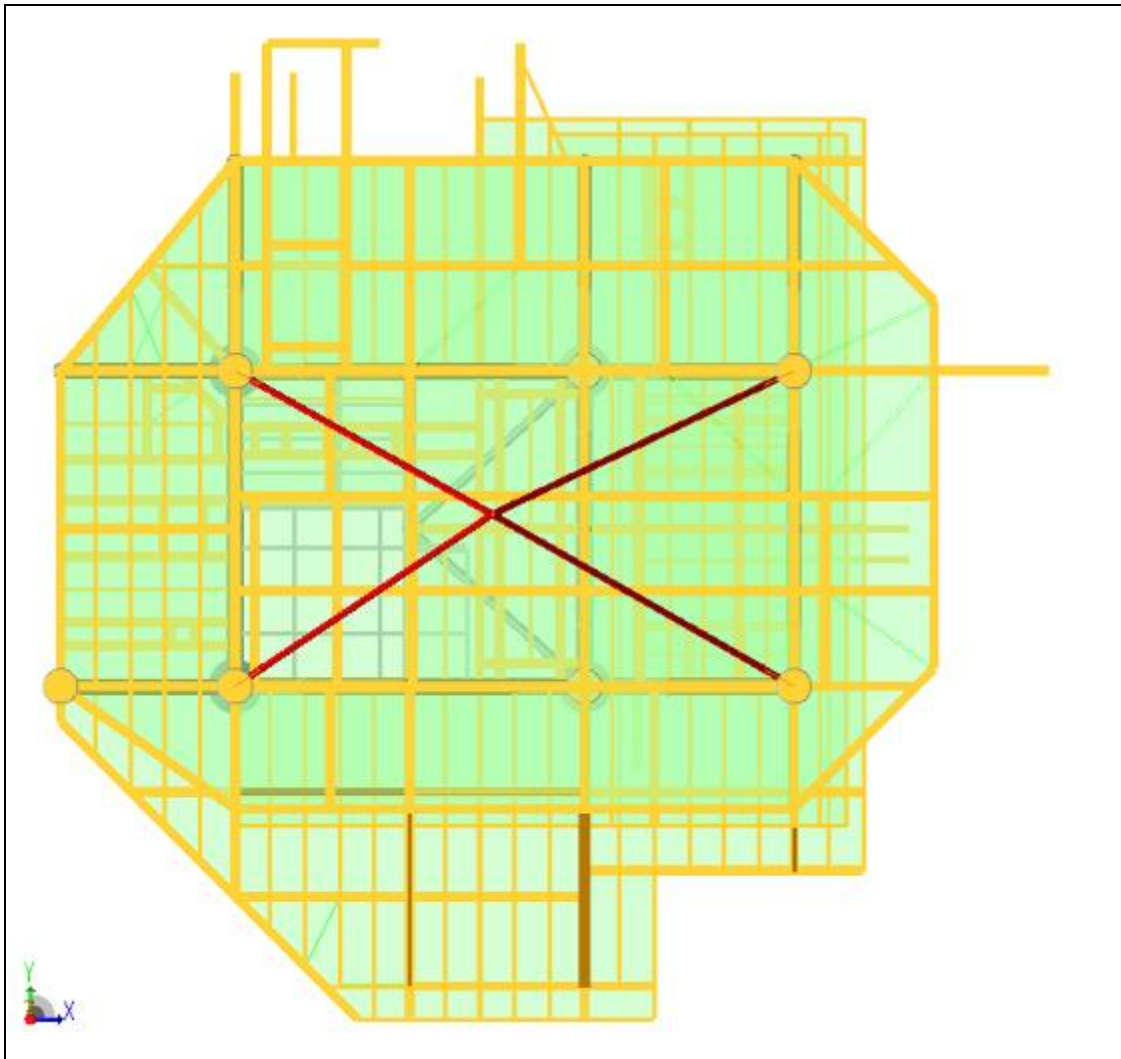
Modello Strutturale – Piano el +23.51 m
